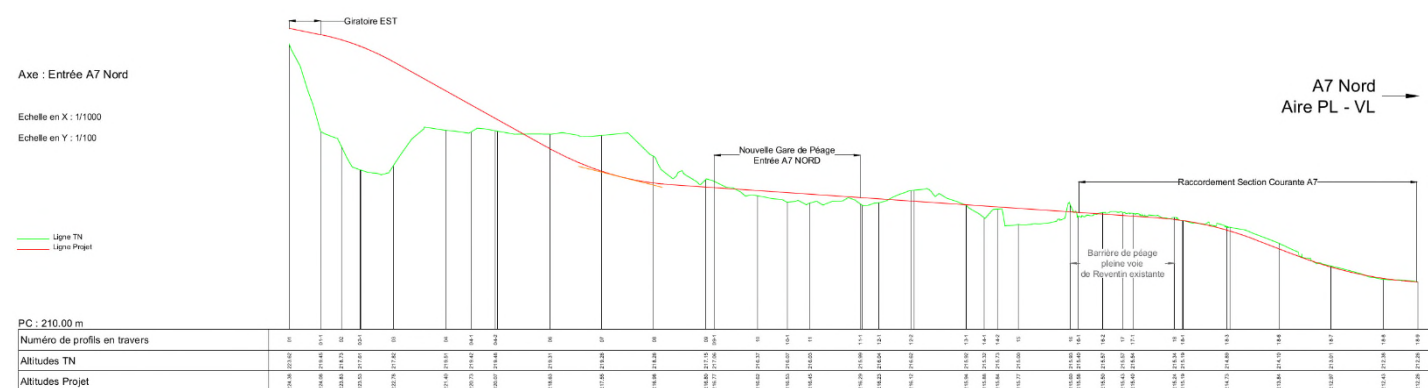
Profil en long de la bretelle d'entrée sur l'autoroute
